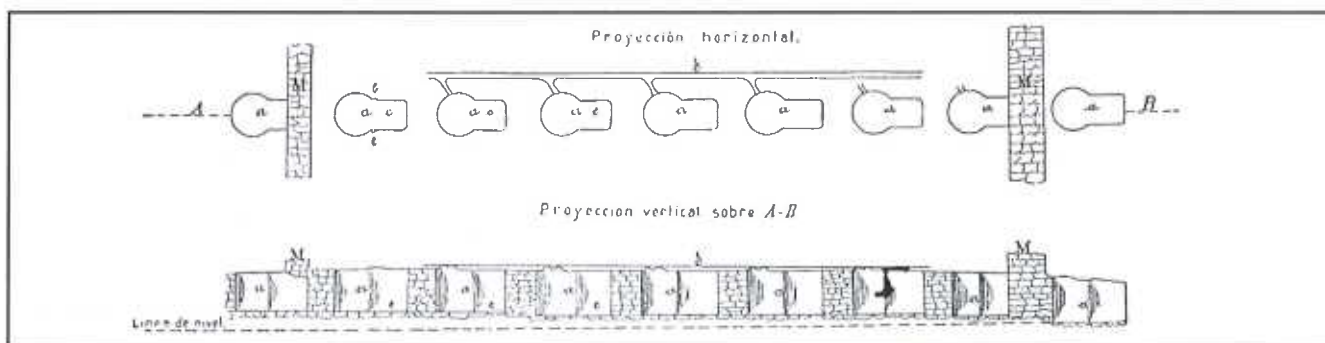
Planta y sección del lavadero de mineral hallado en el Coto Fortuna, tomado del ingeniero alemán Würzburger y publicado por Bravo Villasante (1913).
